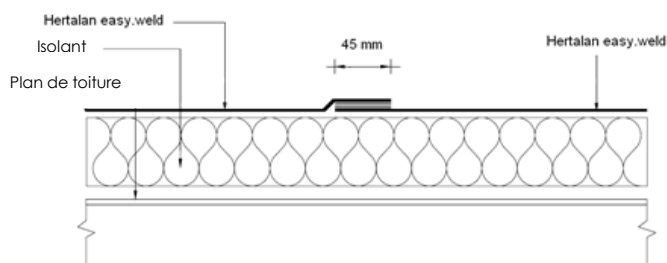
Joint longitudinal HERTALAN EASY WELD
